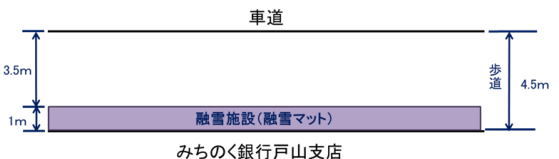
歩道部平面図 (②みちのく銀行戸山支店前)
